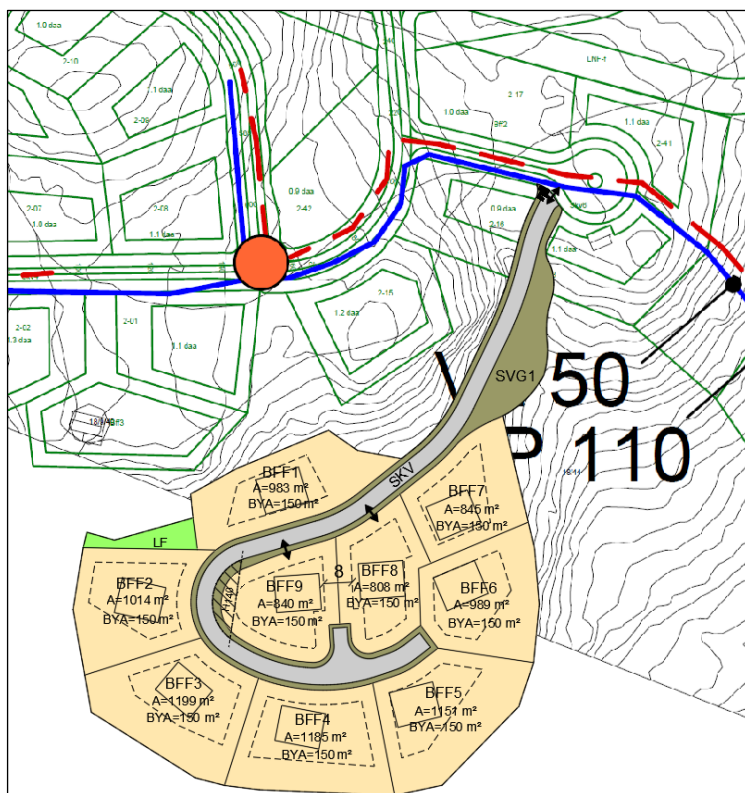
Eksisterende flomveier sett sammen med plankartet.
